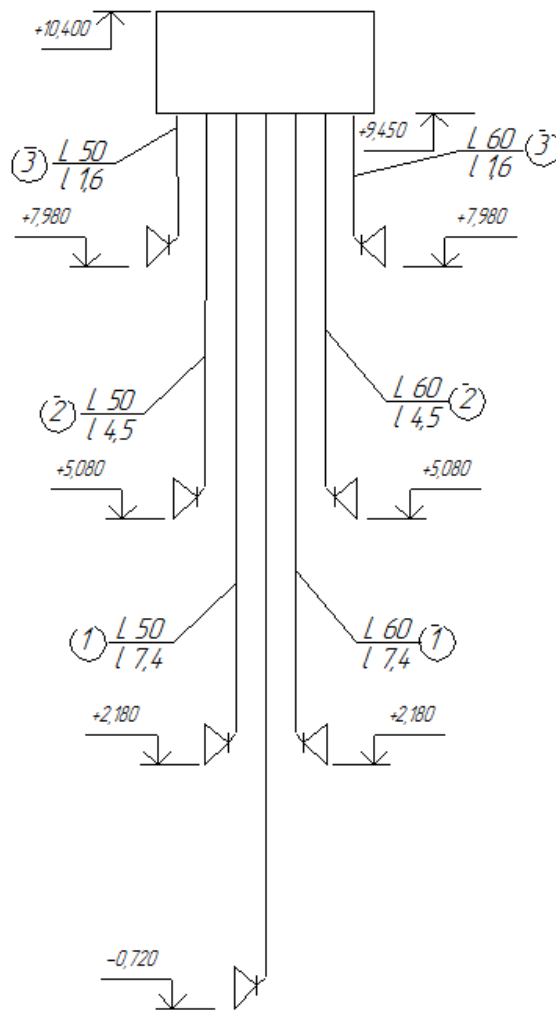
Расчётная схема вытяжной вентиляции
